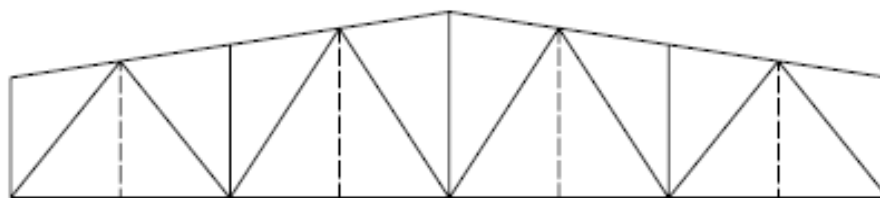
Armadura Tipo Tijera Warren utilizado en el Teatro José F. Saybe
